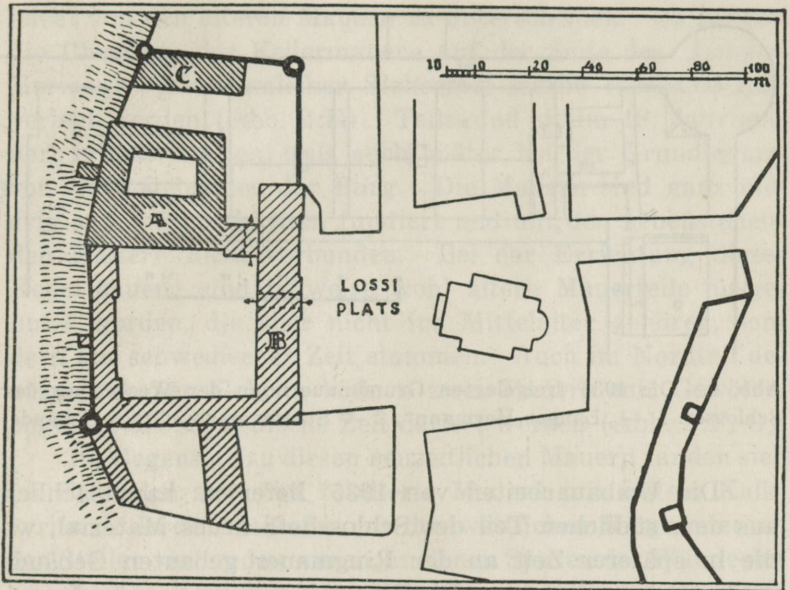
Grundriss der Tallinner Burg vor 1935.
